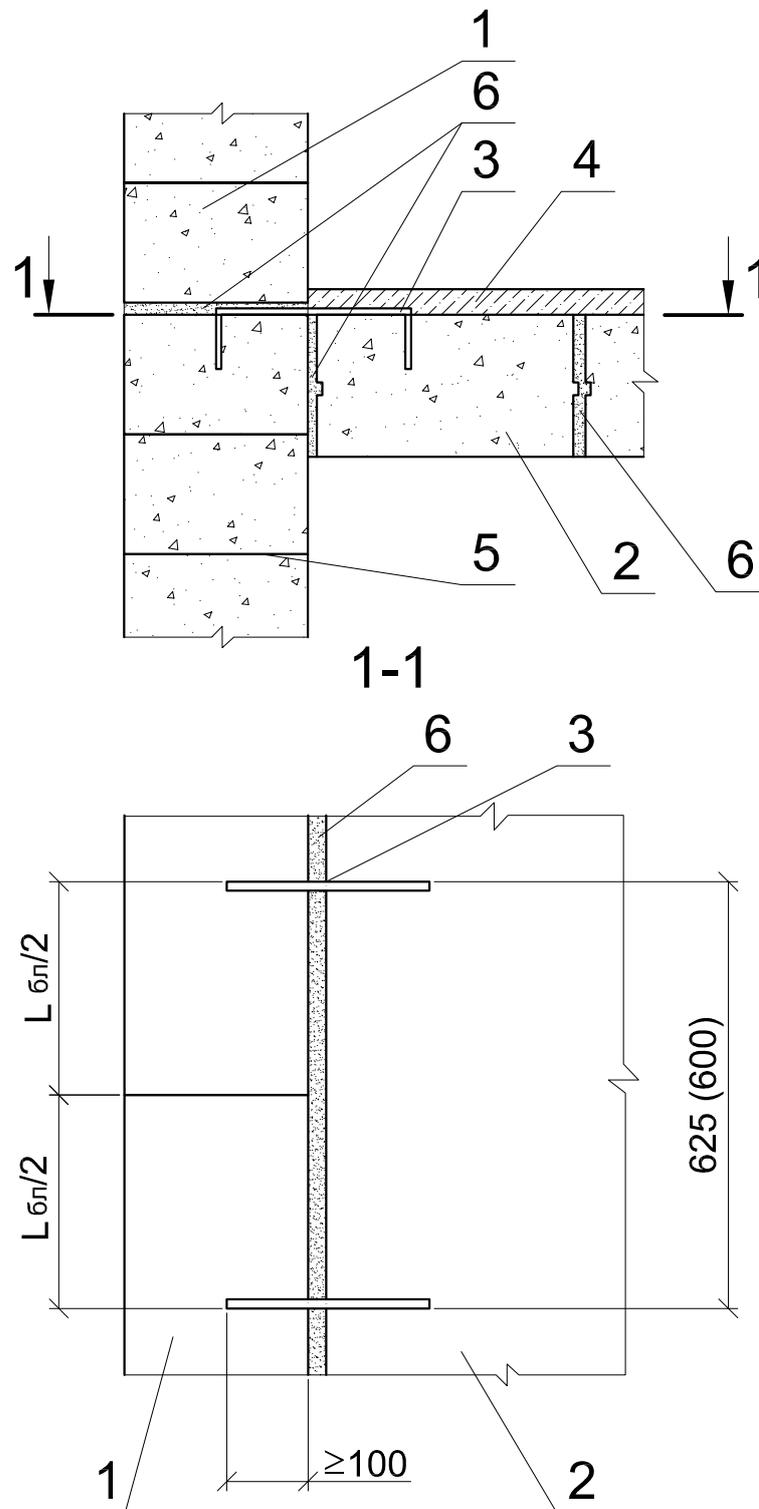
Опираие железобетонных сборных плит перекрытия на наружную несущую стену из блоков ГРАС и железобетонный пояс
